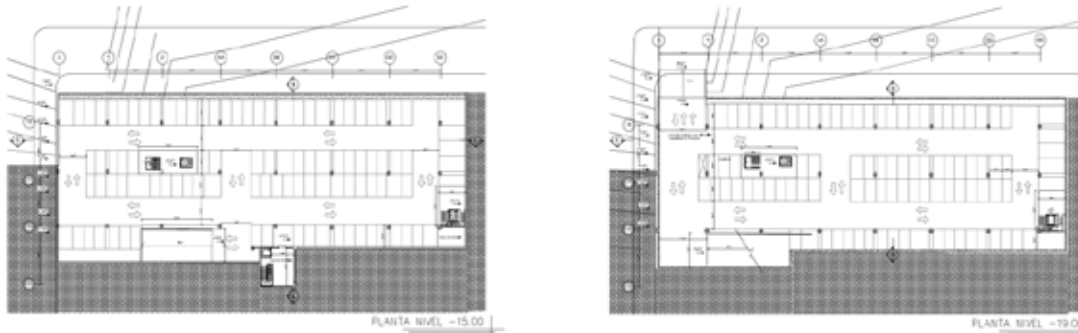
Vista Planta Nivel -15.00 y -19.00 - Malavé (2017)
